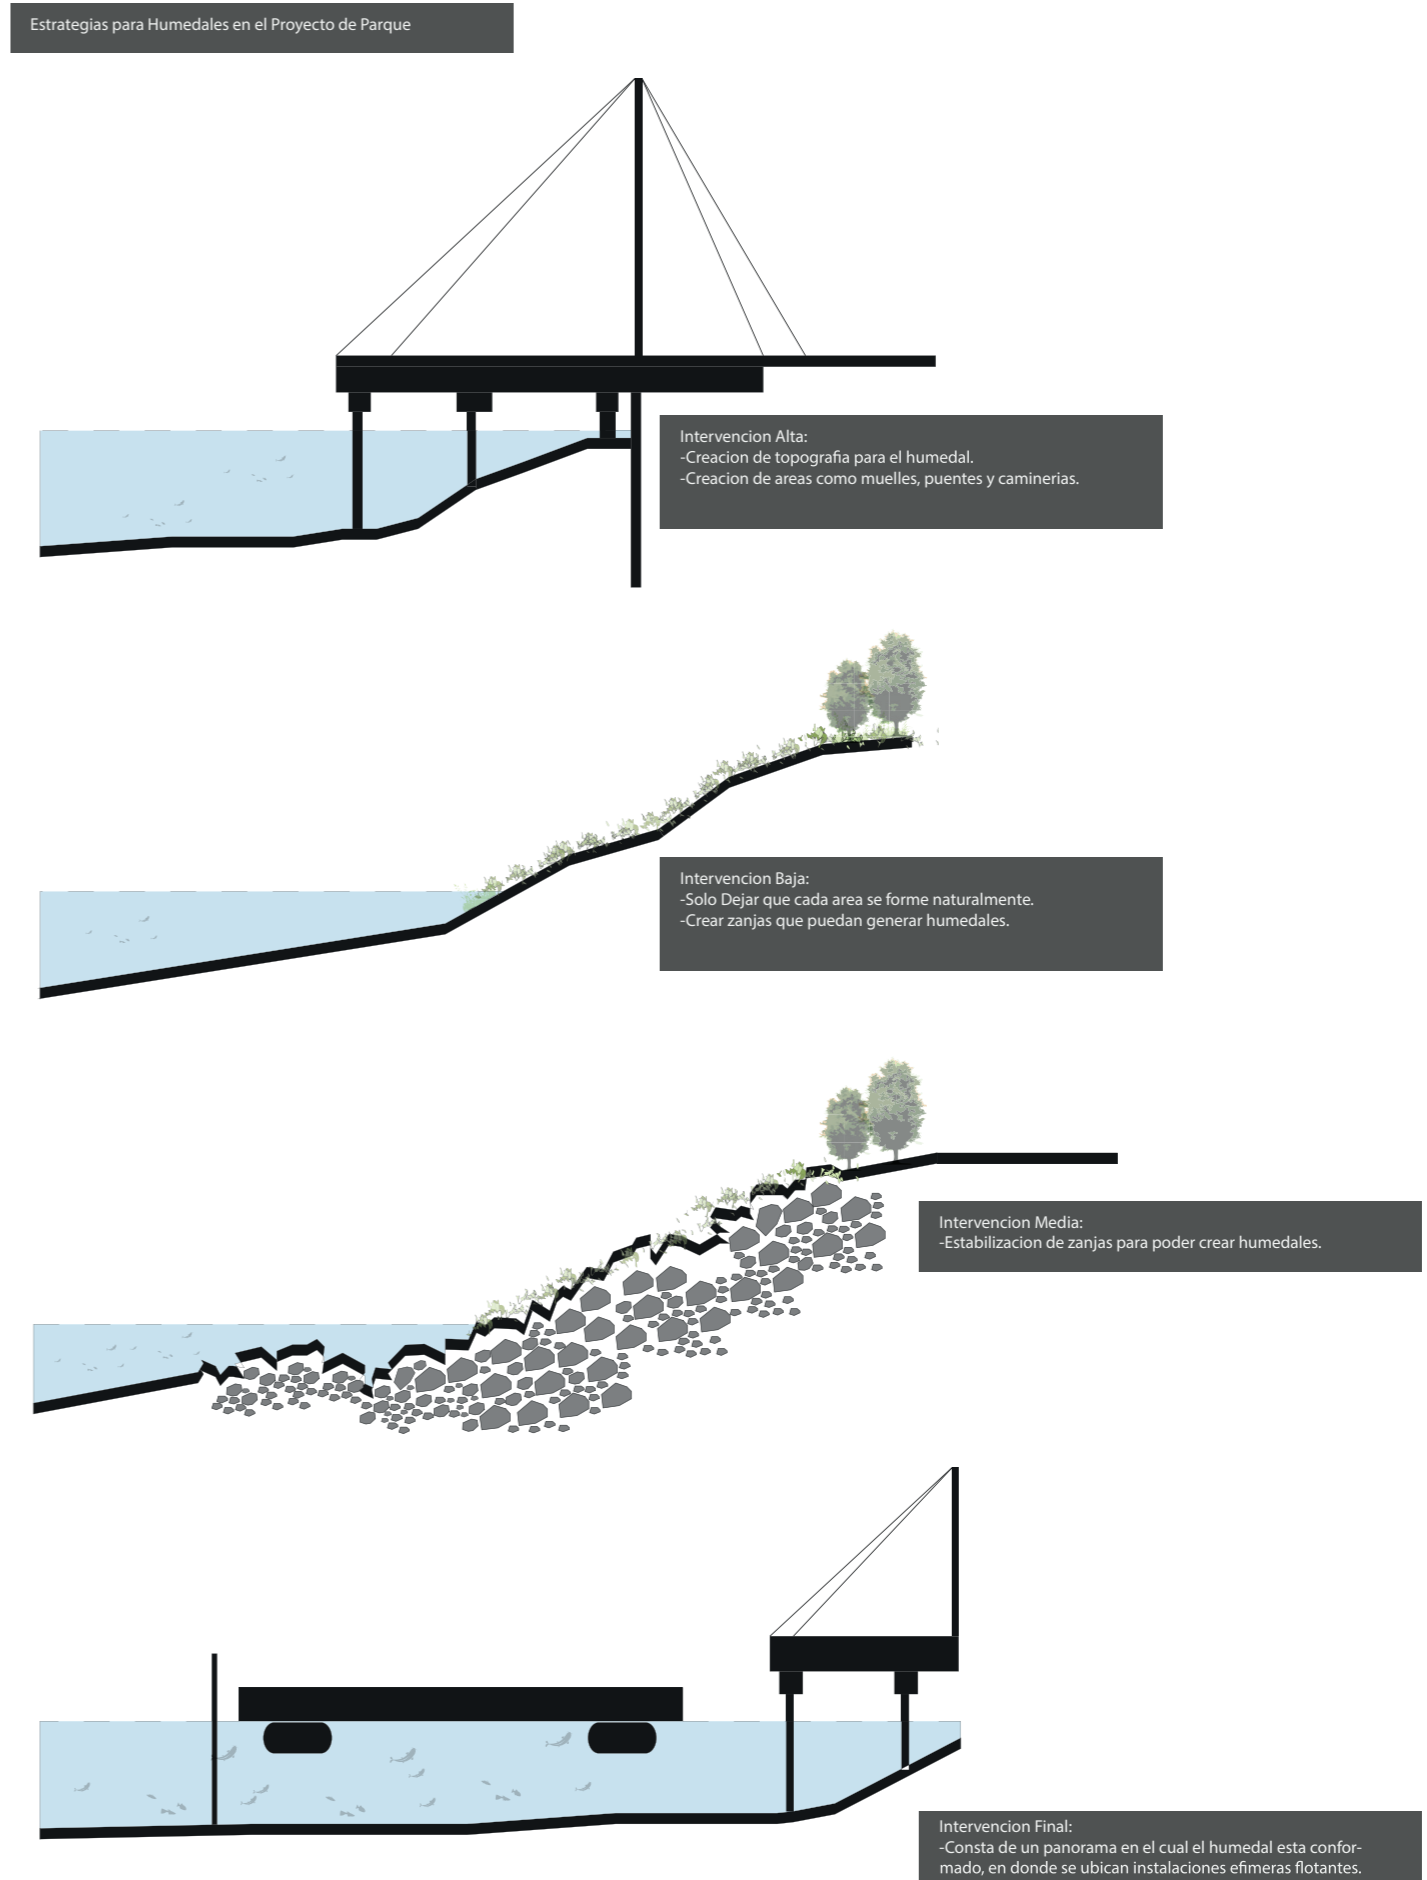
Plan Urbano de Intervención: Vista de Intervención en sección
